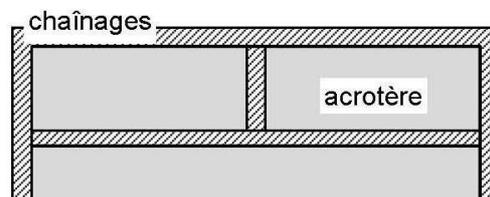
Exemple d'encadrement des éléments en console vertical
